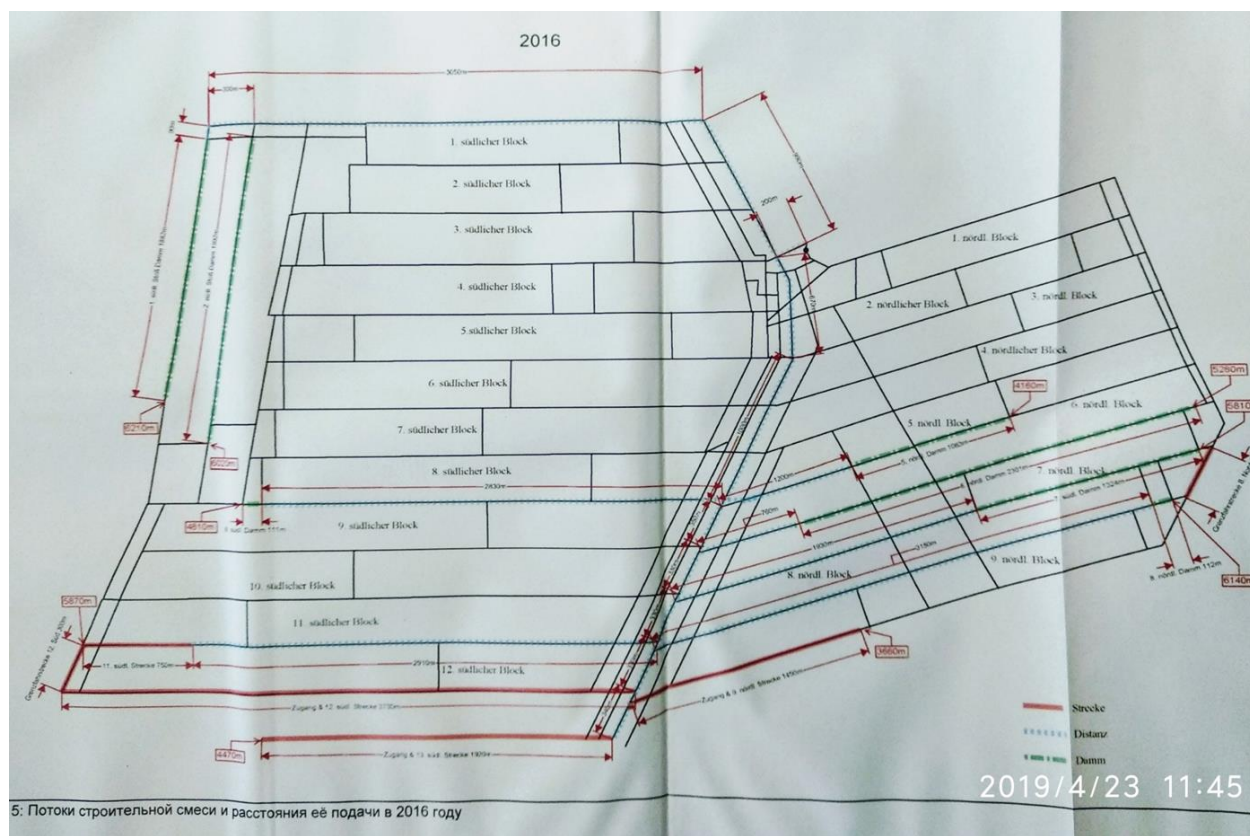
Фрагмент проект DMT подачі будівельної суміші з поверхні у виробки ШУ Покровське (тампонаж, набризкбетон, литі смуги)
